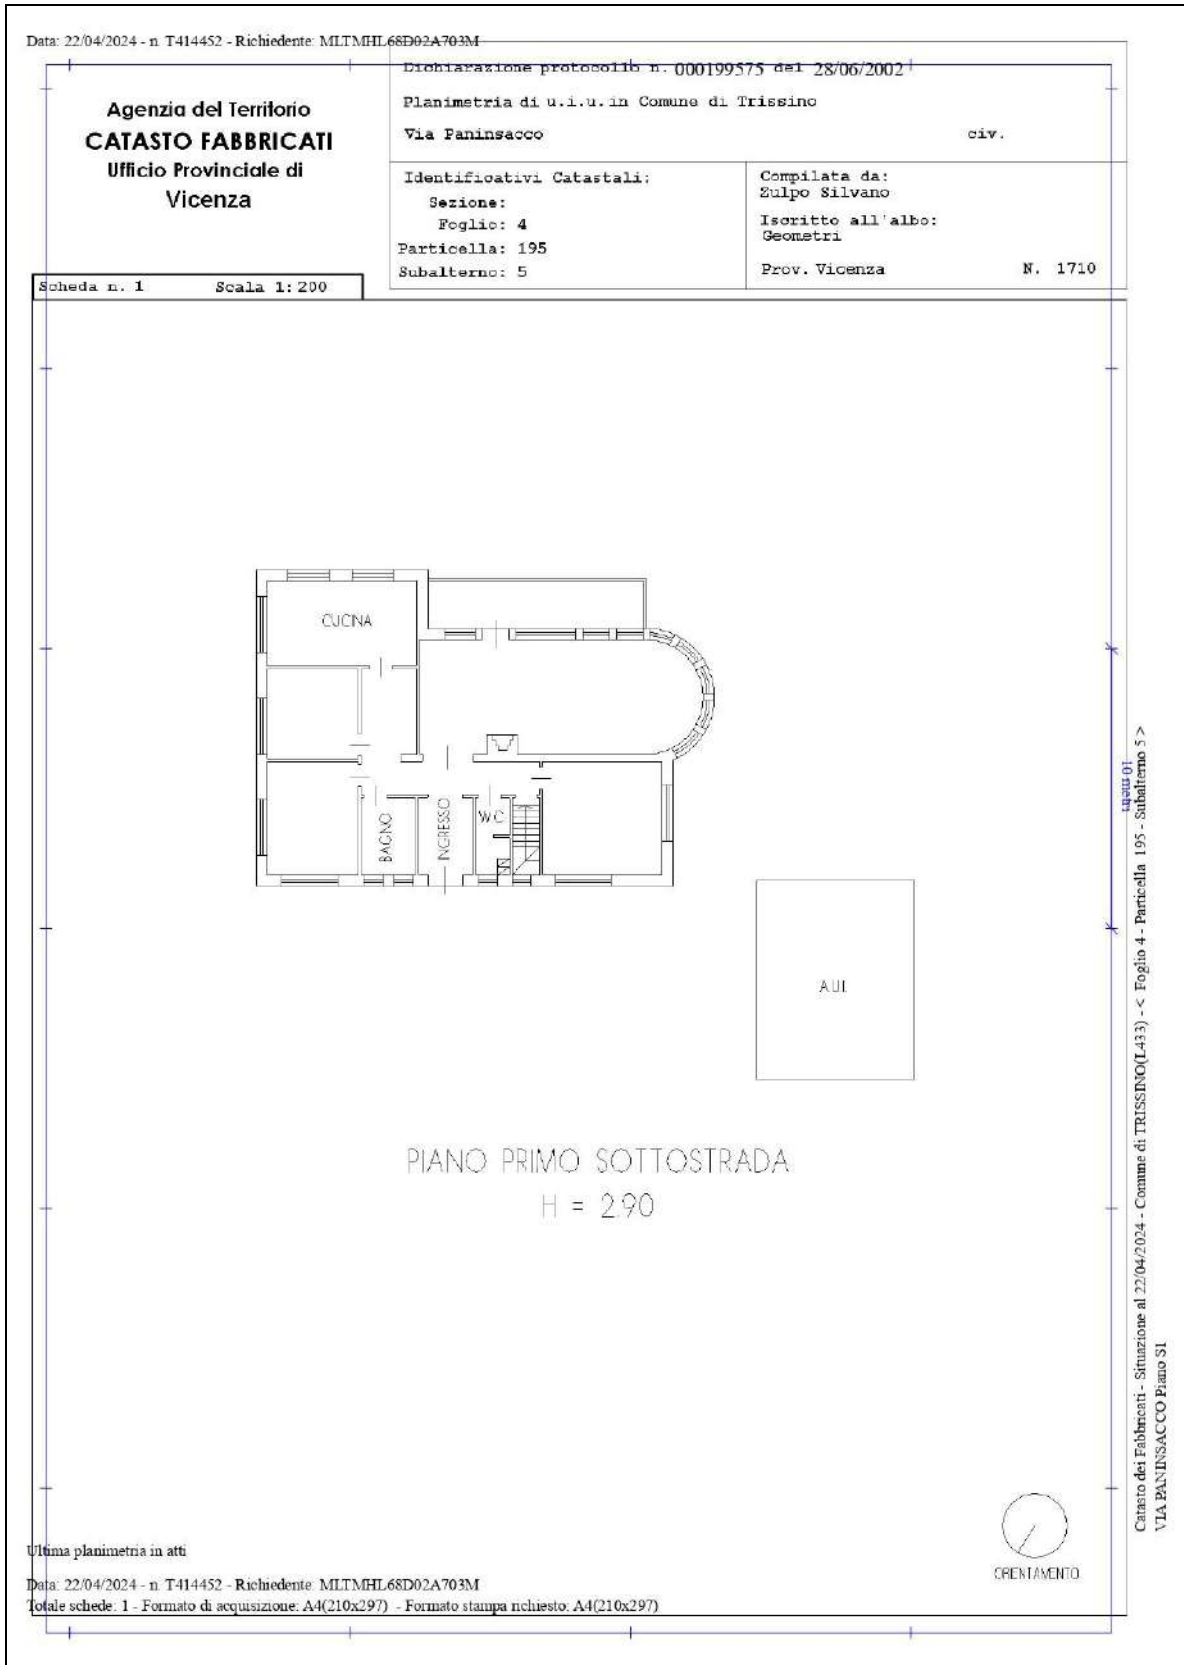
c. Planimetria catastale del bene – Foglio 4 mappale 195 sub. 5.
